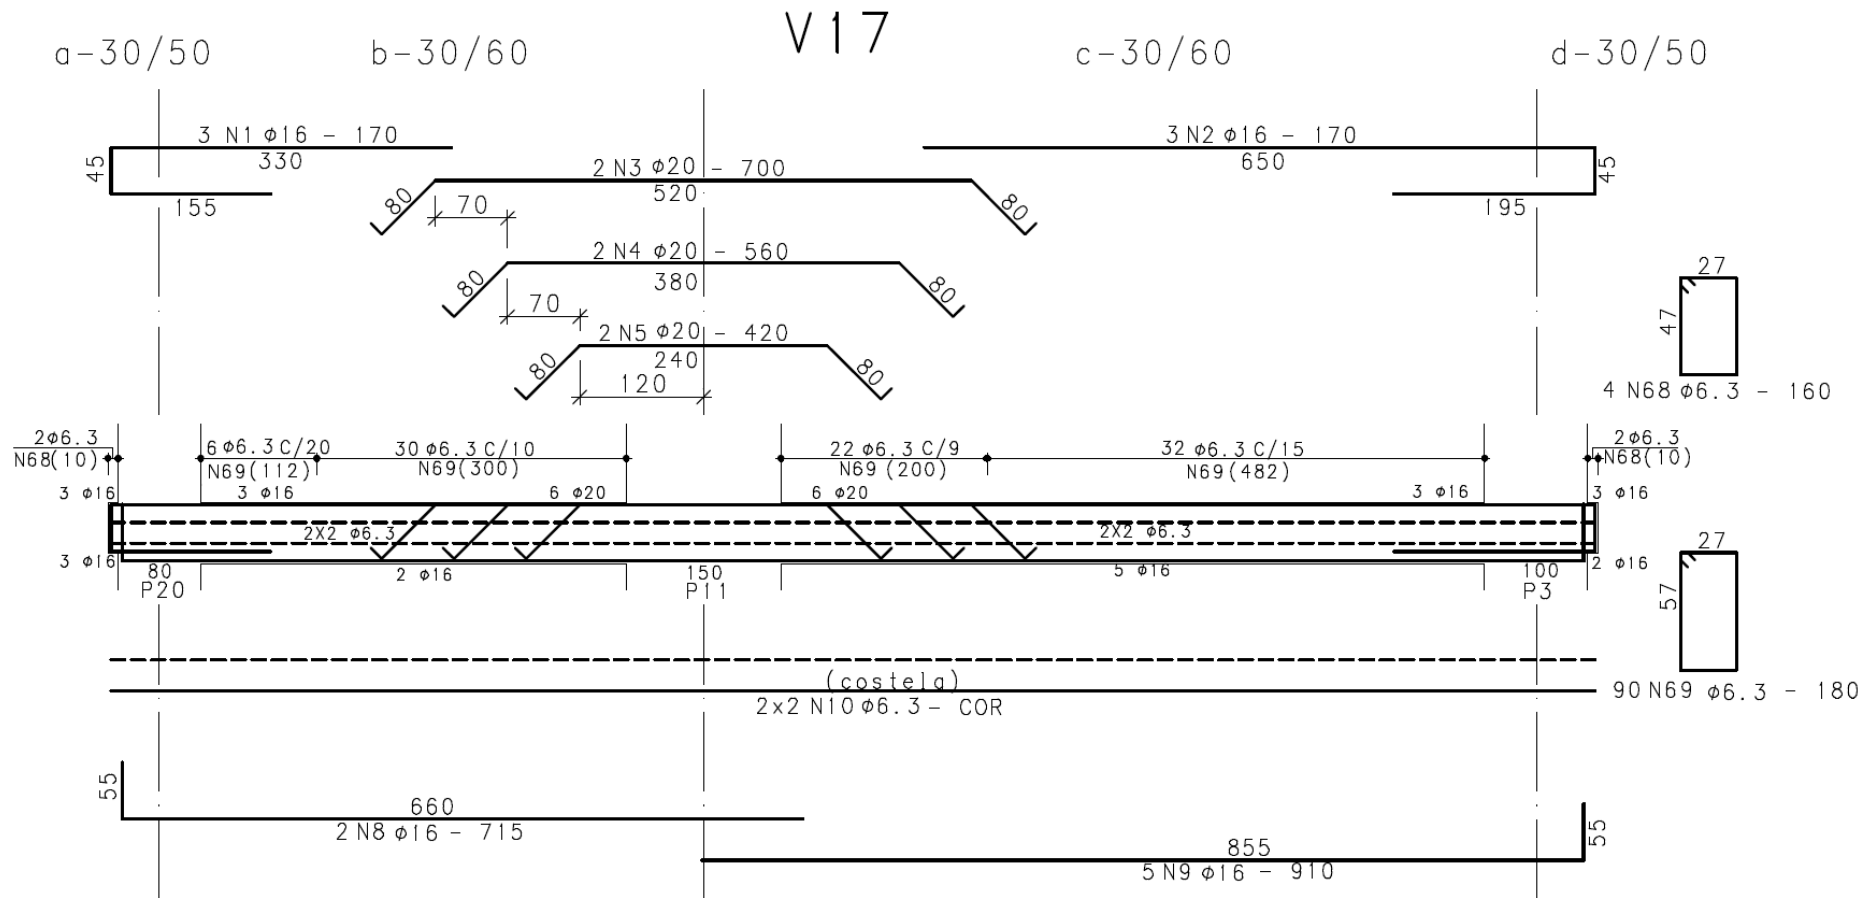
Armação da viga V17 do pavimento tipo.
